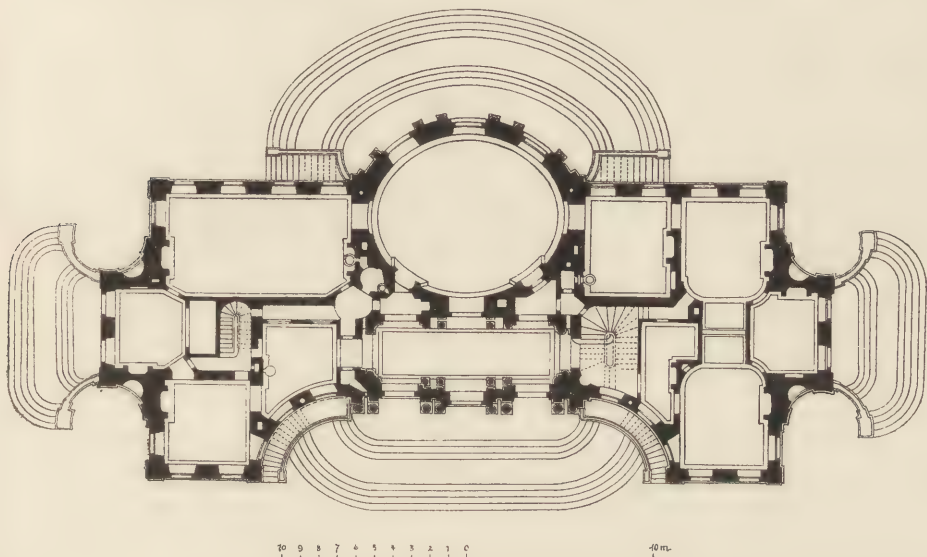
Schloss Monrepos. Grundriss.
